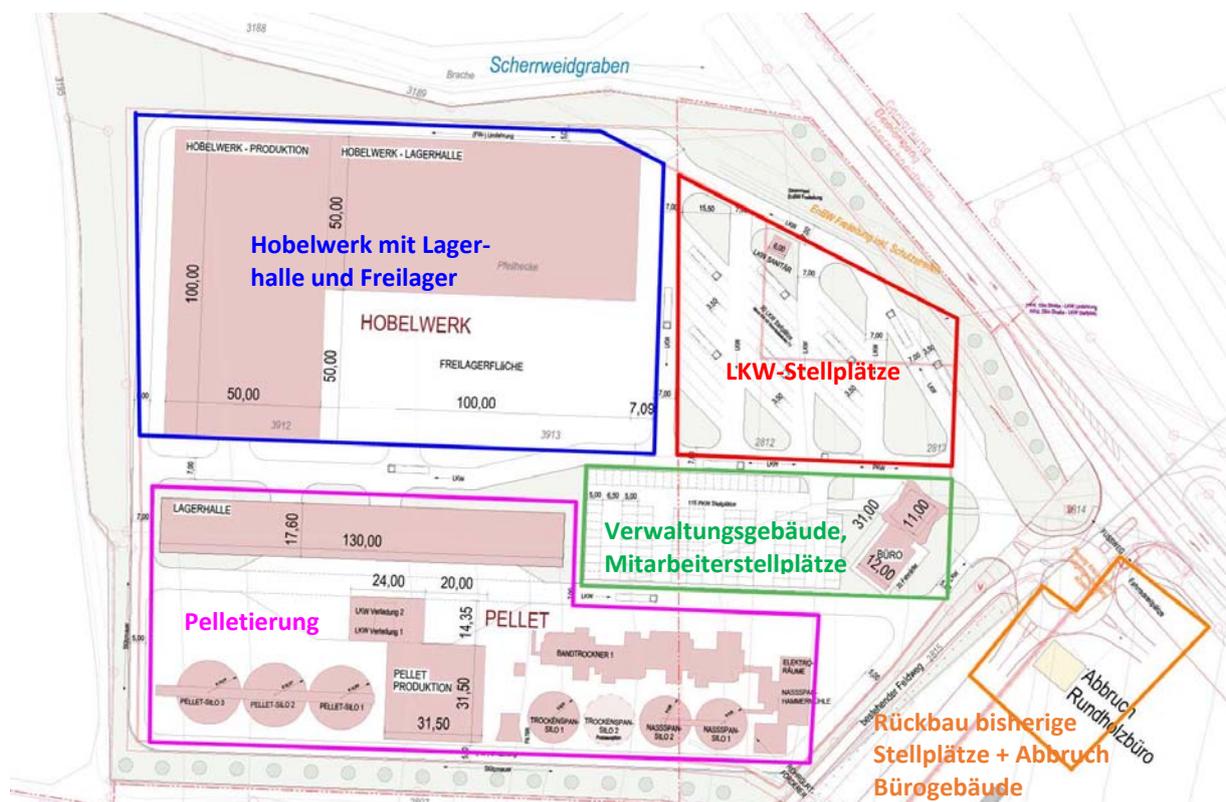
Aktuelle Planung Erweiterungsfläche (Vorentwurf Koch Architektur Generalplaner GmbH, Ellwangen, Stand Mai 2024)
